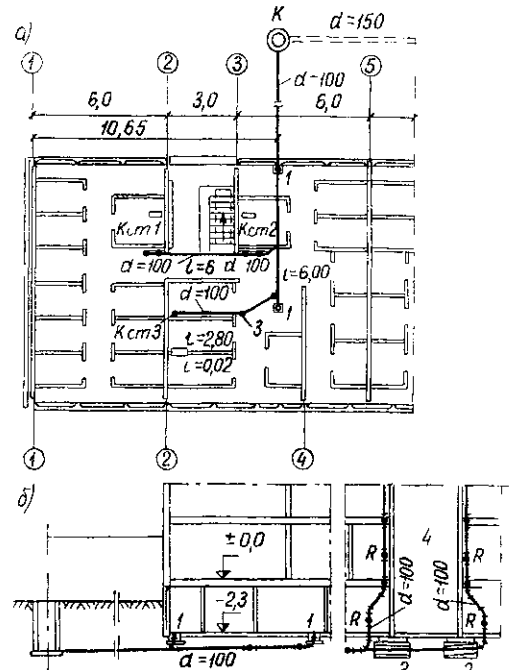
Прокладка канализационной сети ниже пола подвала в крупнопанельном жилом доме с сараями и с несущими поперечными стенами
